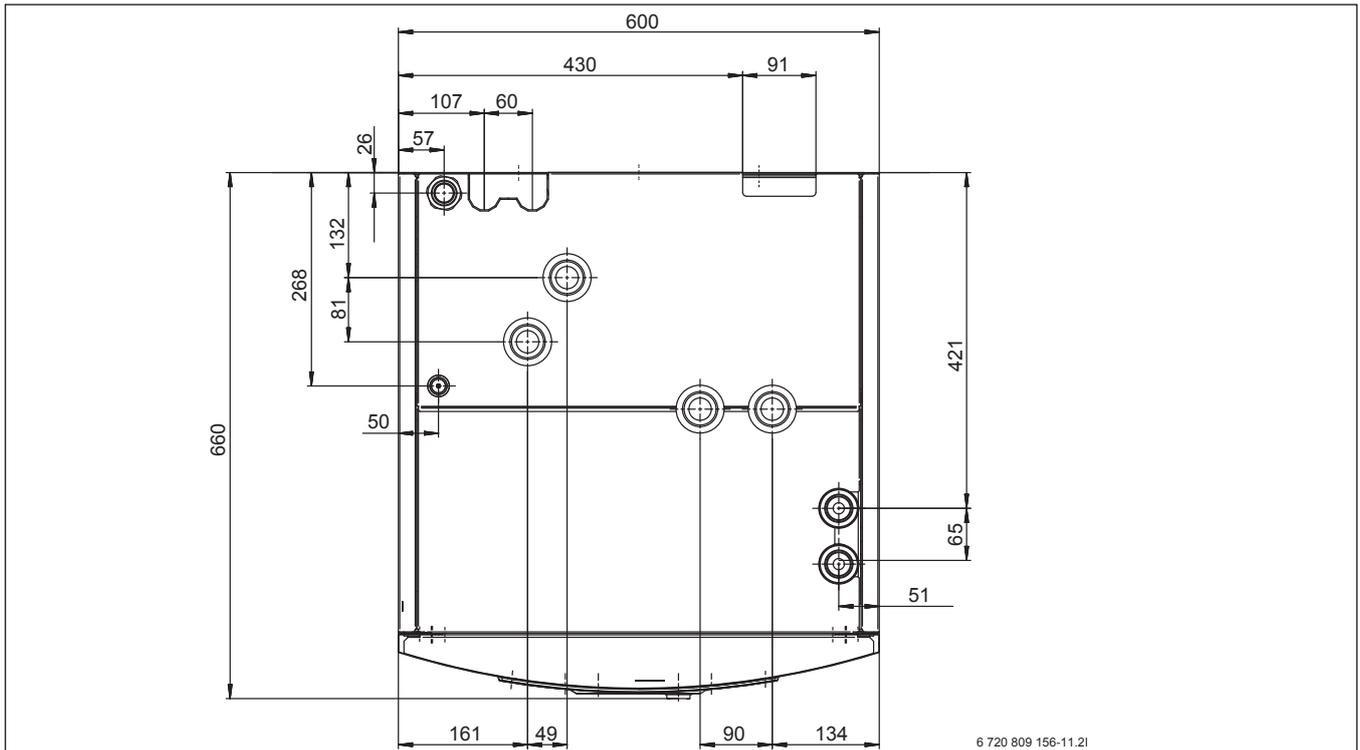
Abstände des Moduls, Draufsicht (Maße in mm)
